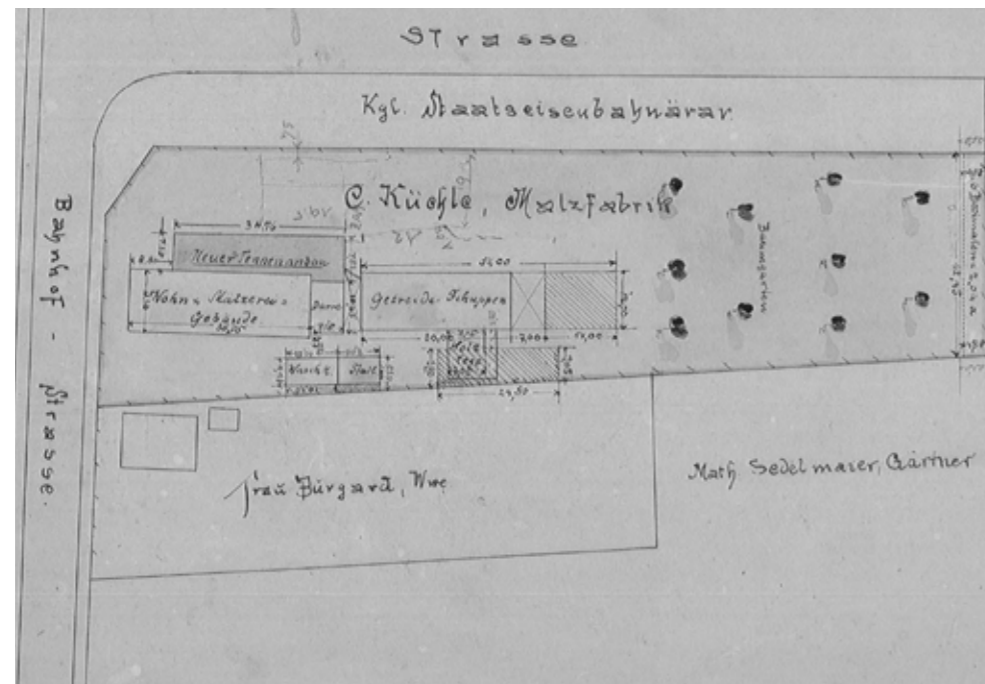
Lageplan Malzfabrik Stuber & Krieger, 1901
